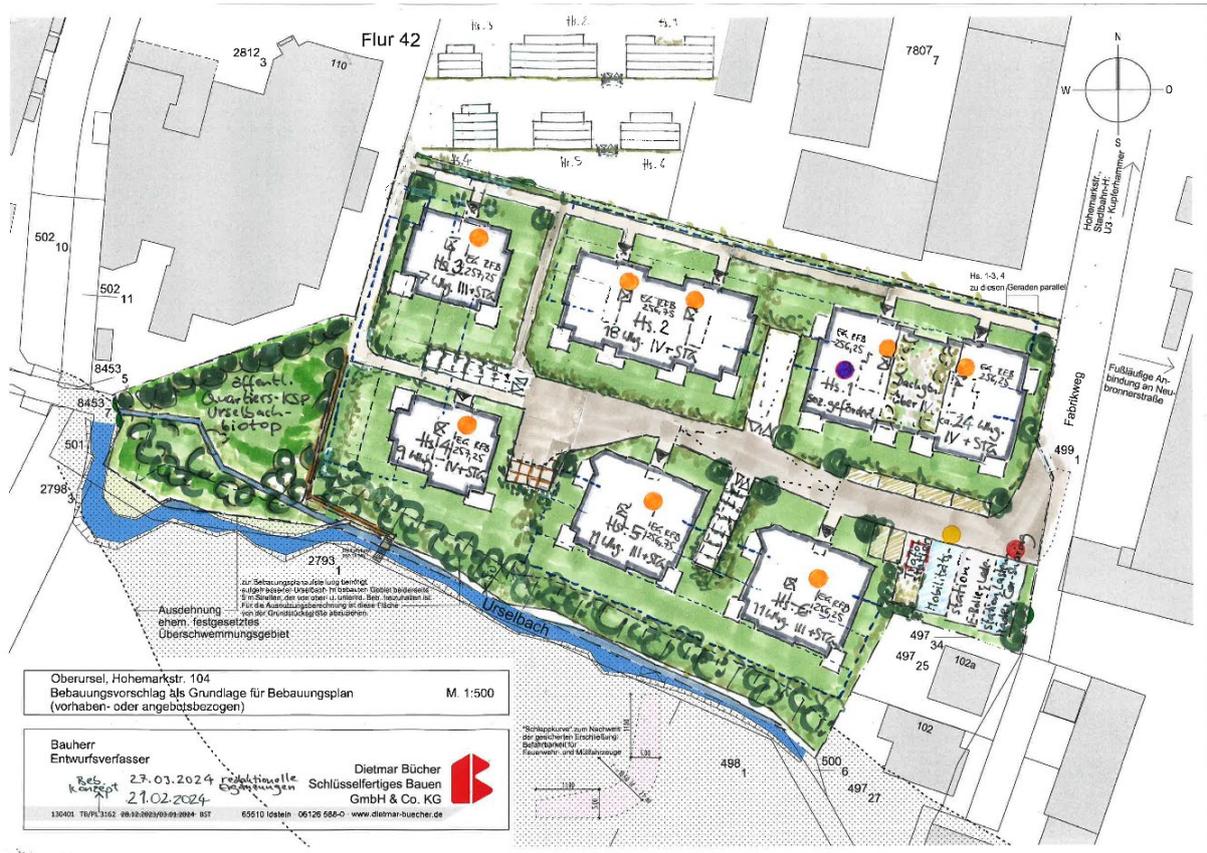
Bebauungsplanvorschlag als Grundlage für den Bebauungsplan – Oberursel, HoheMarkstraße 104 (Stand 27.03.2024)
